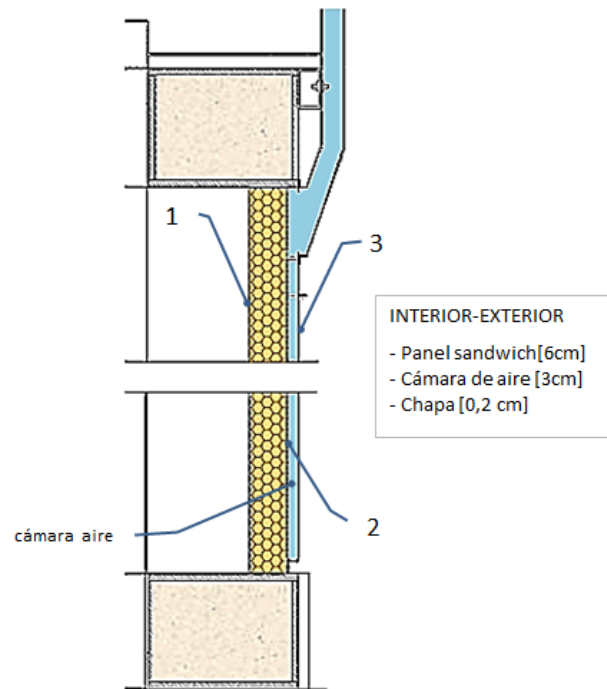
Solución constructiva de la fachada ventilada forzada
